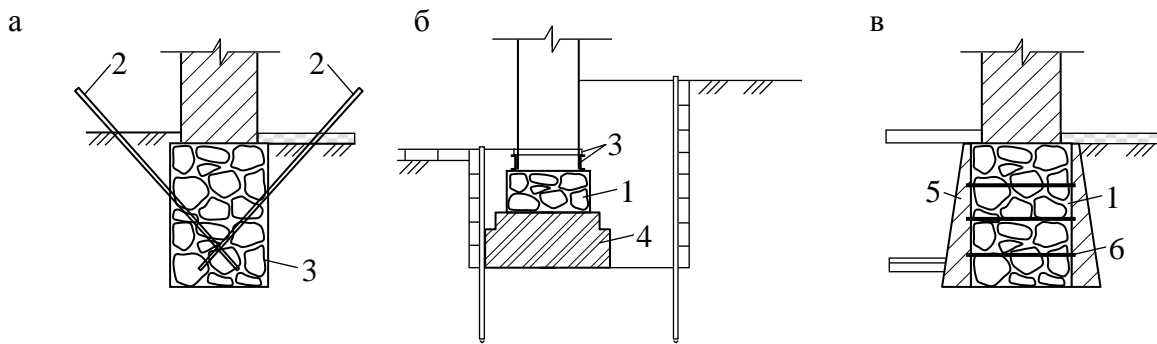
Укріплення фундаментів: а – цементациєю; б – заміною слабкої ділянки; в – бетонною чи залізобетонною обоймою; 1 – існуючий фундамент; 2 – ін'єктор; 3 – металічні укріплюючі балки; 4 – заново влаштована частина фундаменту; 5 – обойма; 6 – анкеруючі стрижні
